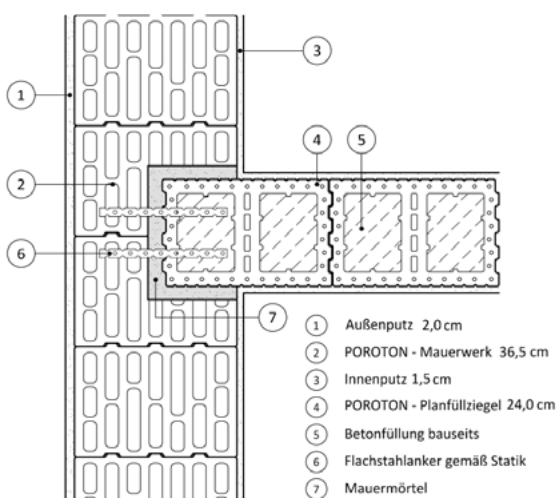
Die Wohnungstrennwände aus Planfüllziegel-mauerwerk und die Stahlbetonwandscheiben sind mittels Schlitzeinbindung in die Außenwände ausgeführt worden.
